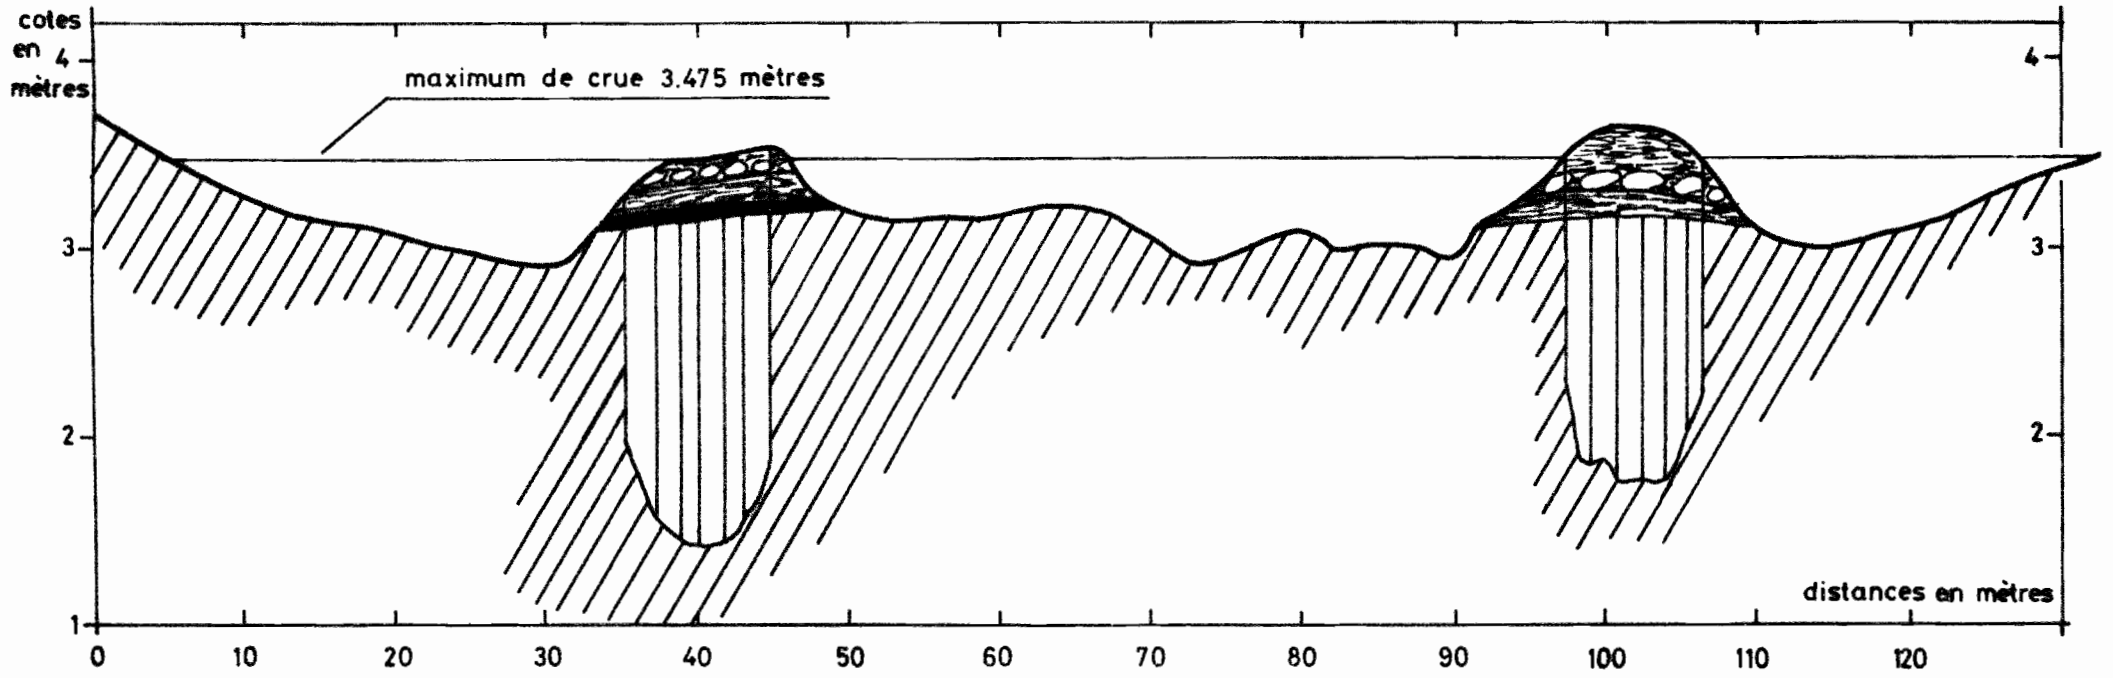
PROFIL EN TRAVERS - PONT SAKARIALOU BRANCHE SUD - le 11/04/1987
